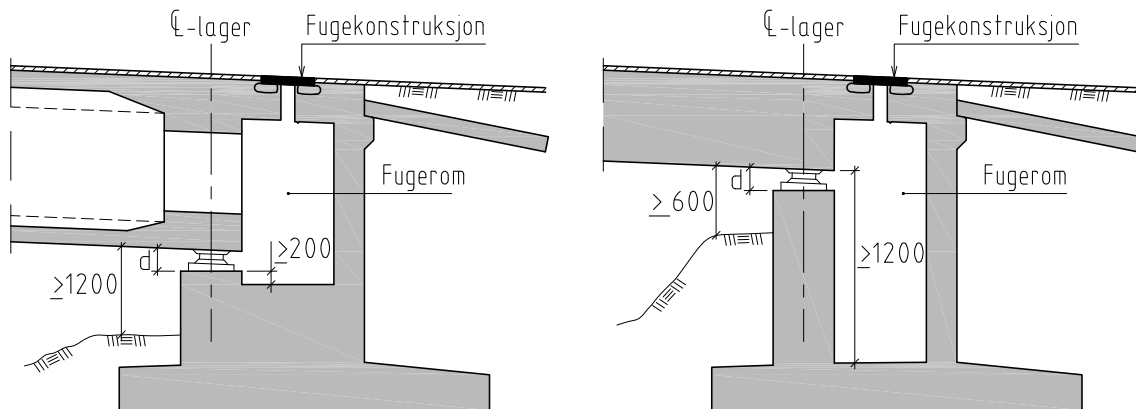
Eksempel på tilkomst til lager fra utsiden
